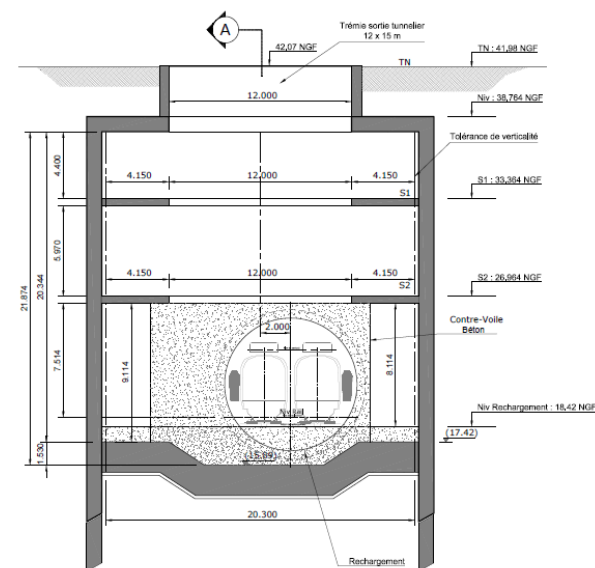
Coupe-type d'un puits de sortie de tunnelier
